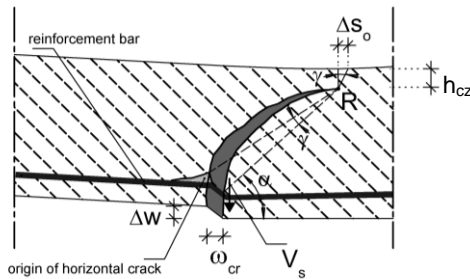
Biegeverformungen des Bewehrungsstabes im Bereich des Biegeschubrisses für einen Stahlbetonbalken.
